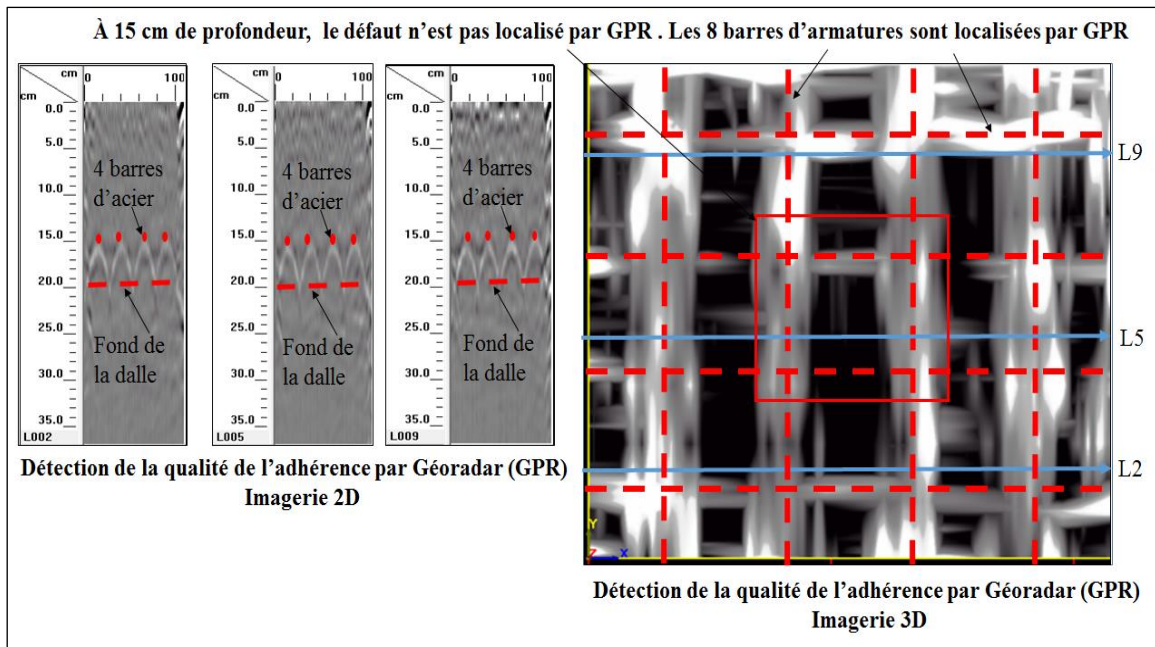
Détection de la qualité de l'adhérence par Géoradar – Défaut placé à 15 cm de profondeur de la dalle - Dalle N° 8.
